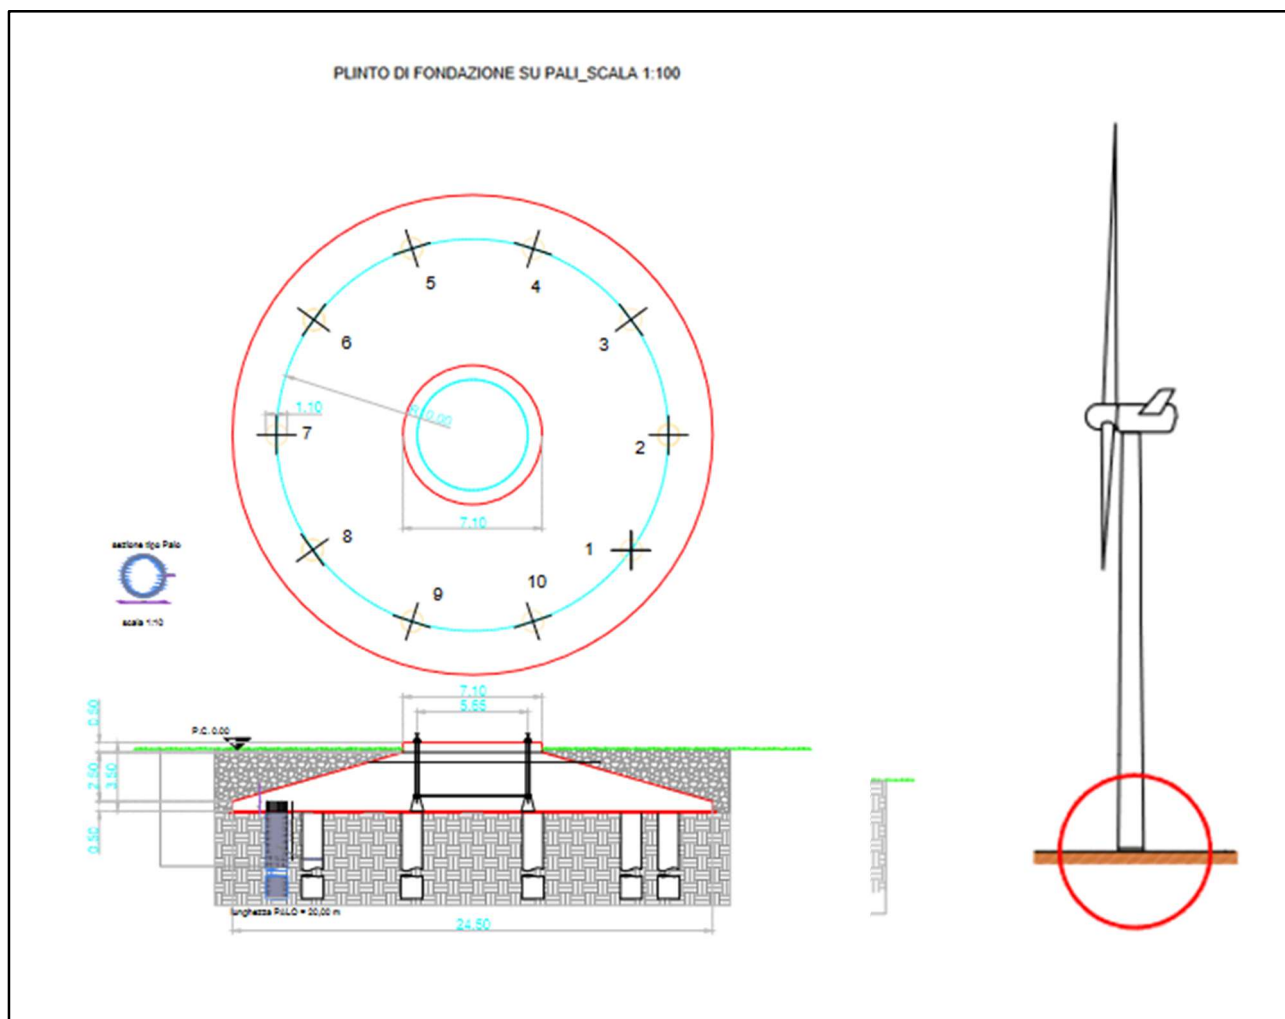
Dettaglio pianta e sezione fondazione
